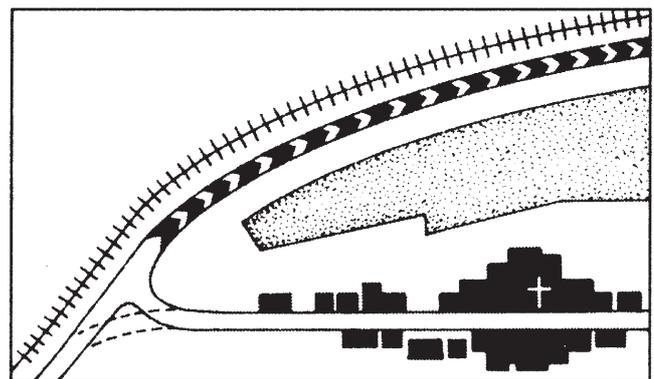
„Horizontale Linienführung von Verkehrsachsen z.B. Umfahrungsstraßen, Entlastungsstraßen, Parallelführung von Straße und Bahn (Lit. 6)“
